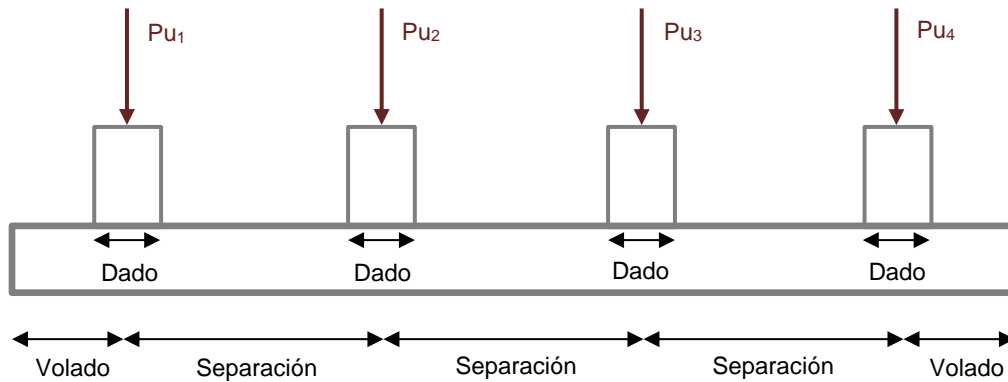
Zapata corrida con volados en los extremos de la losa (Elaboración propia).
